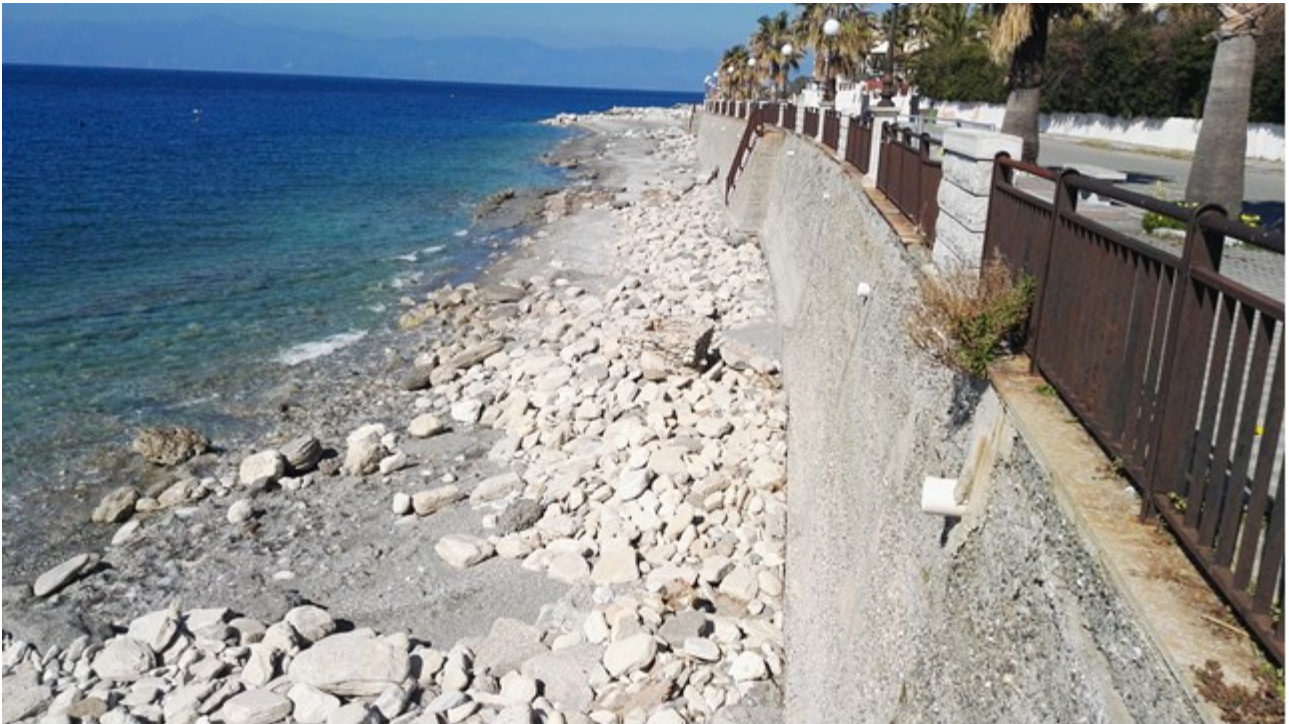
Tratto privo di barriere (forte riduzione spiaggia)
